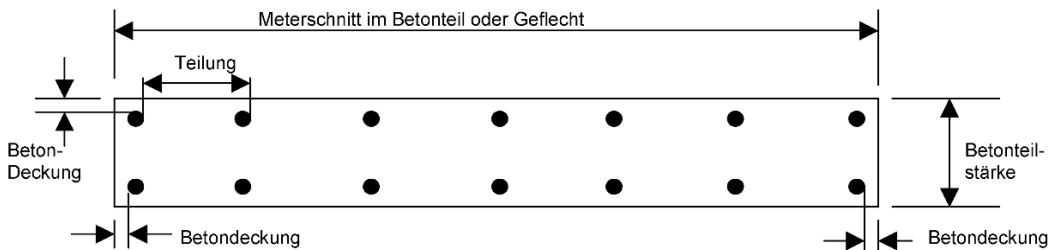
Der Meterschnitt im Betonteil mit den erkennbaren Stahlquerschnitten (obere und untere Lage)
